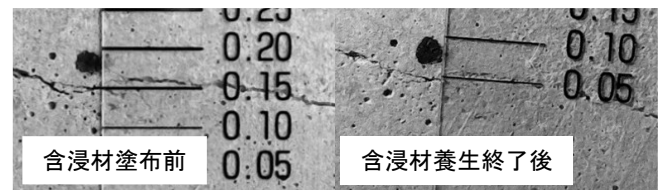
ひび割れ状況確認(脂肪酸系含浸材)
